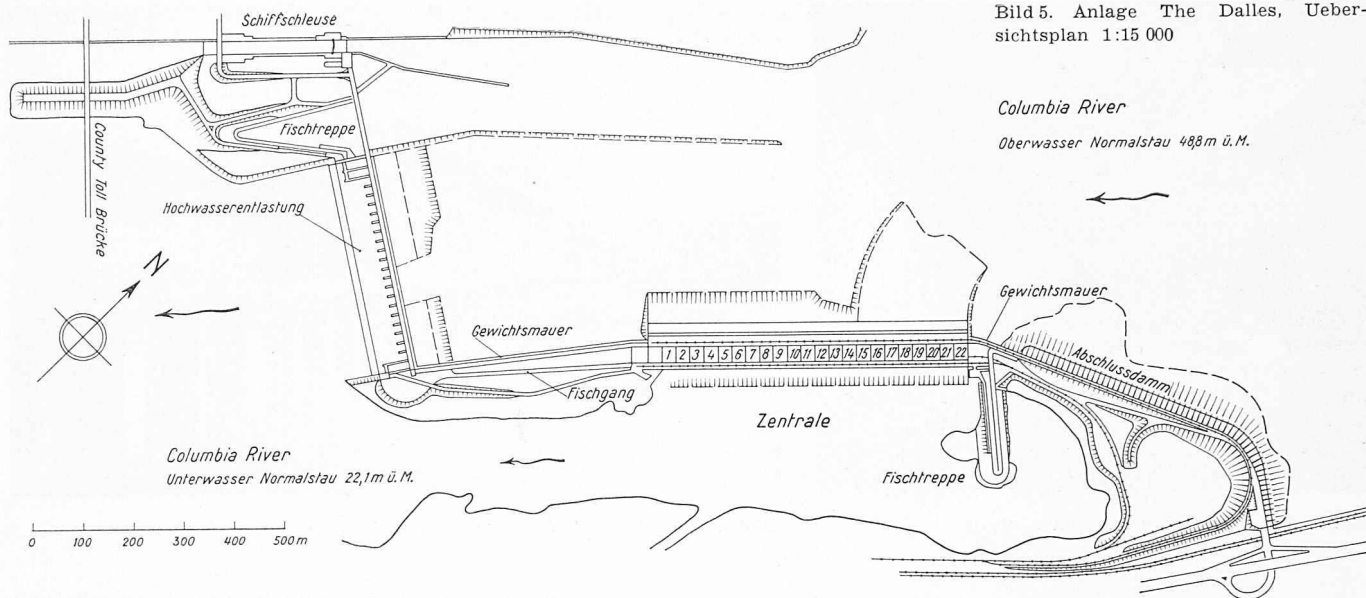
Anlage The Dalles, Uebersichtsplan 1:15 000
